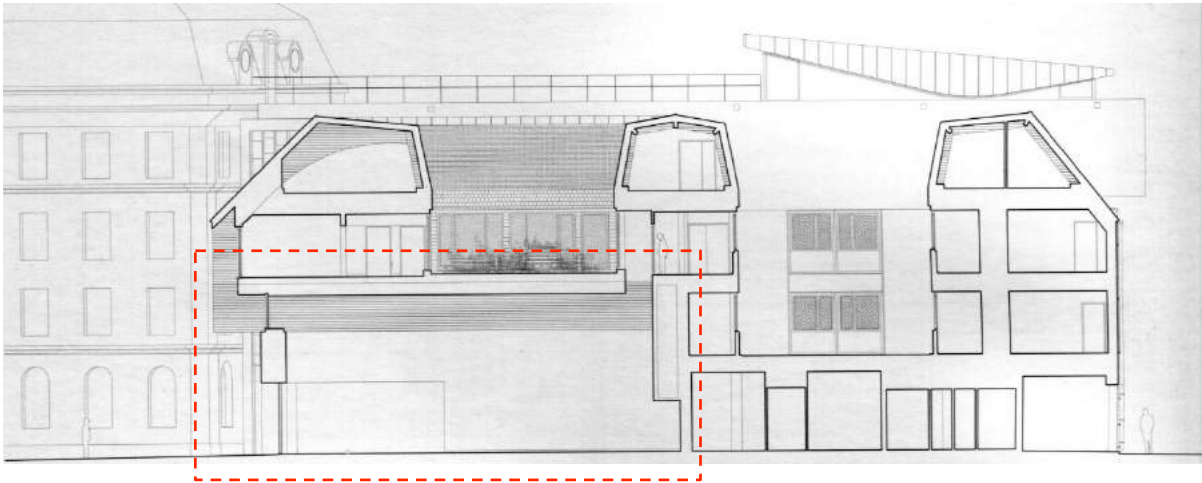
Sezione trasversale 2 / Longitudinal section 2
